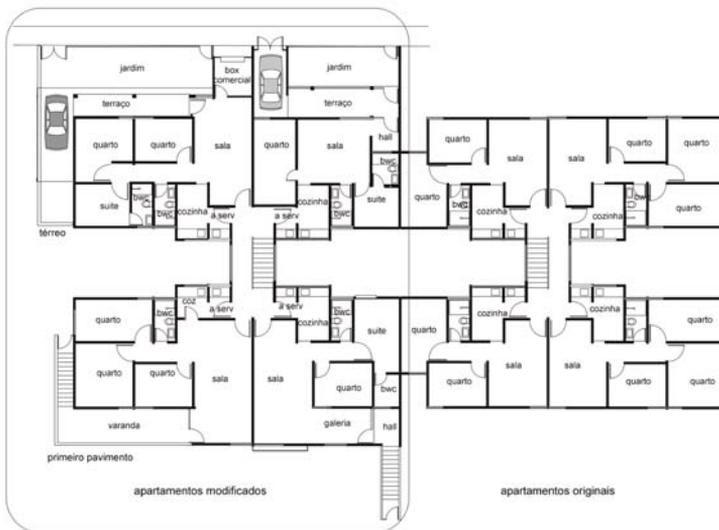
Planta-baixa do bloco típico do Conjunto Cohab Curado 3 com as modificações introduzidas pelos moradores.
